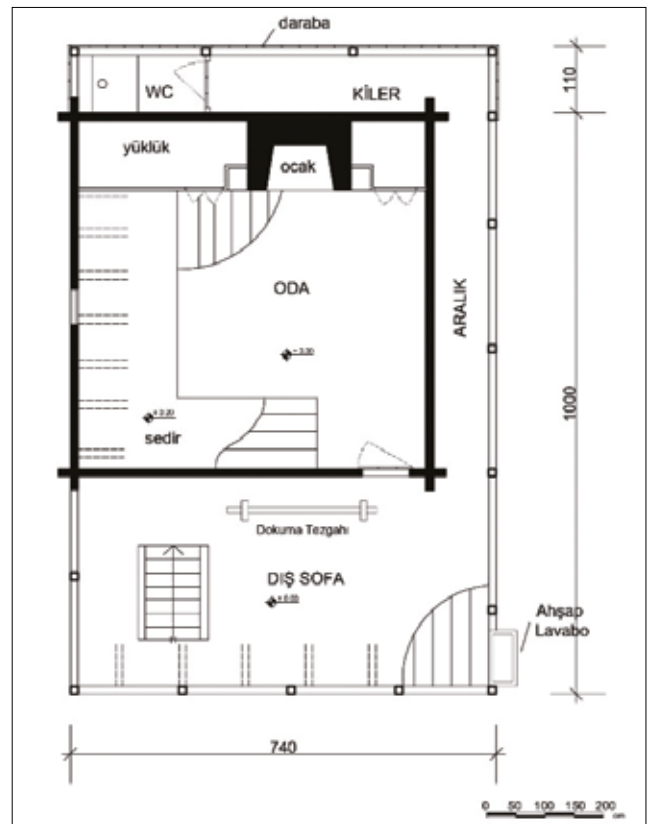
Keşkekçinin Rıza Evi, zemin kat planı, tek odalı, 6 direkli ev (2015) / *House of Keşkekçinin Rıza, ground floor plan, single room house with 6 posts.
